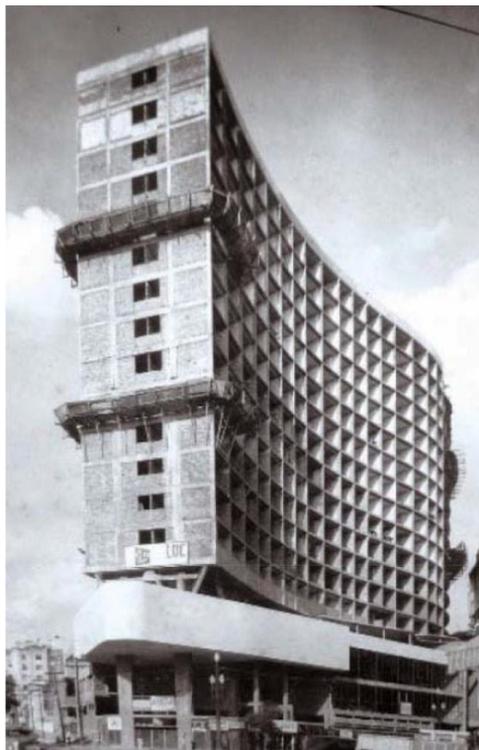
Fachada do Edifício Trussardi (1941)
